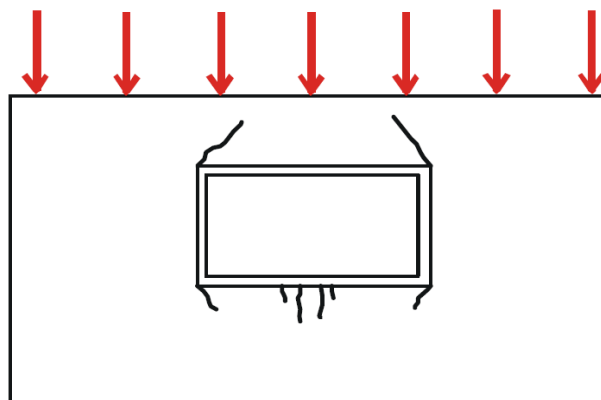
Fissuração teórica em torno da abertura em parede submetida a sobrecarga (THOMAZ, 1989).
